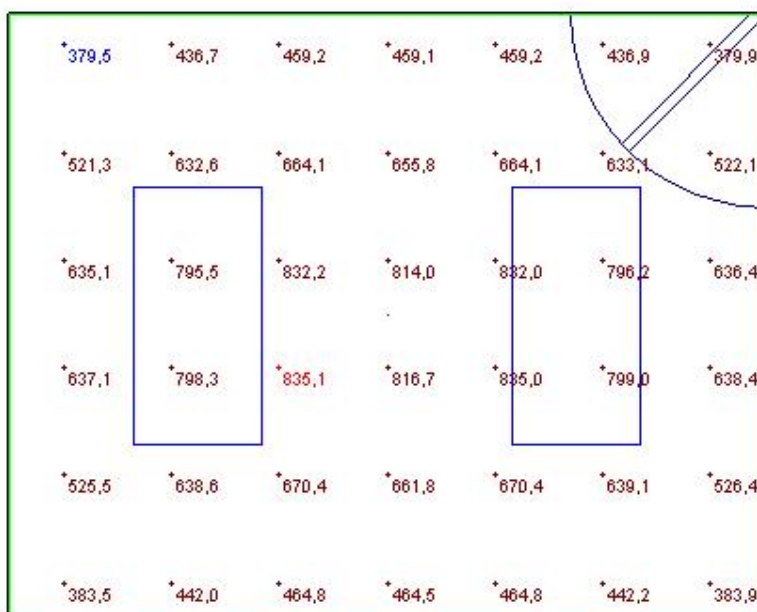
Nivel de iluminación DID (Vista en planta)
